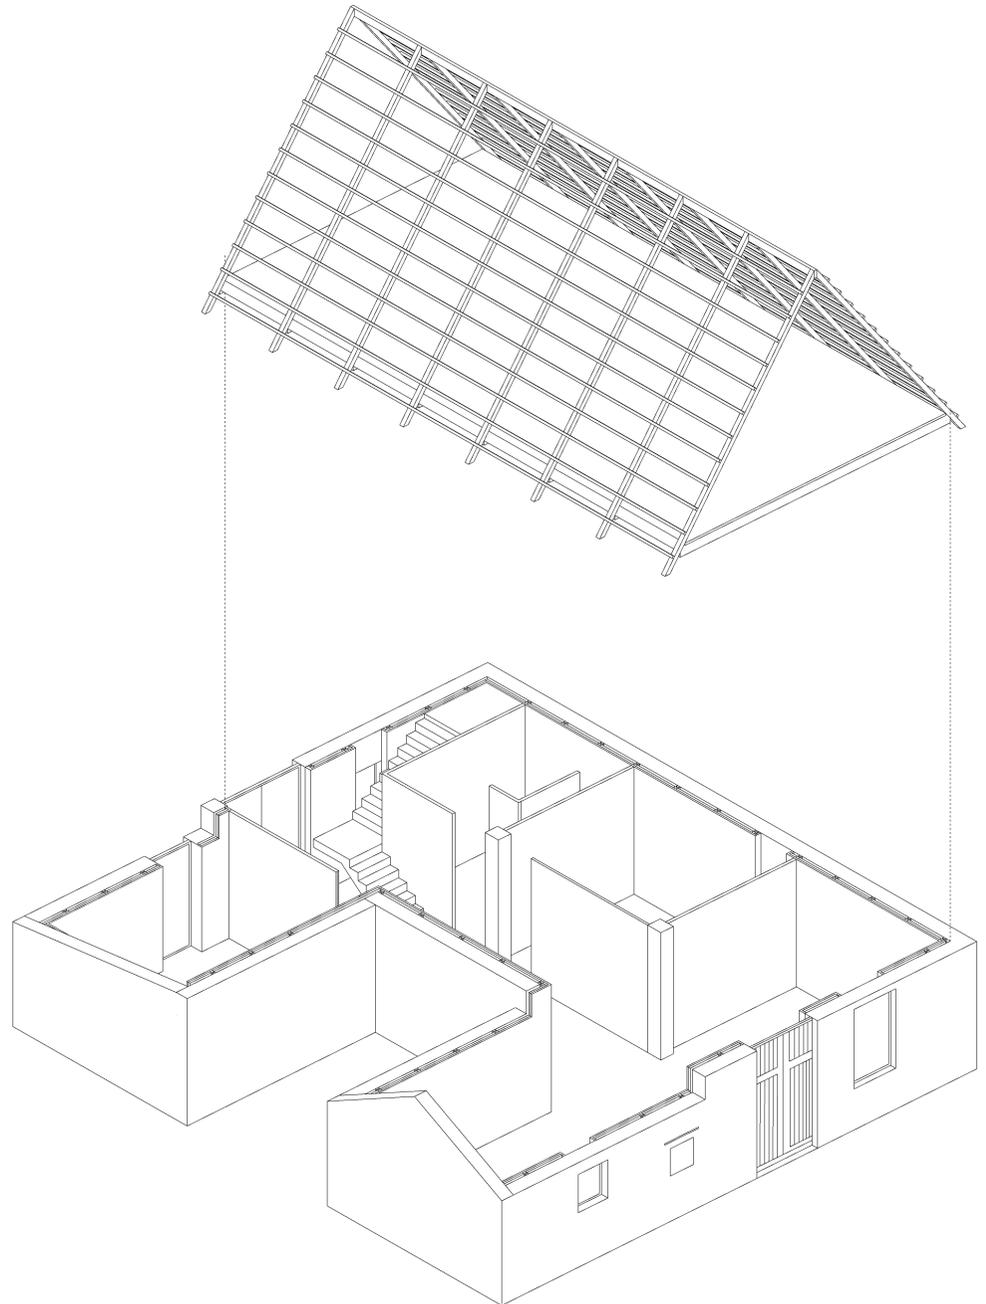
Volumetría constructiva. Fuente : Carlos Fuster Aparisi
